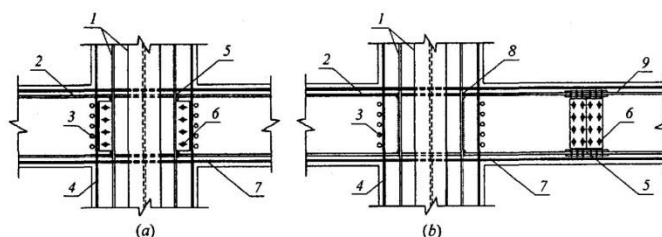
Соединения профилей колонны и балки: *a* - сварное на стройплощадке; *b* - болтовые на стройплощадке; 1 - профиль в колонне; 2 - профиль в балке; 3 - отверстия; 4 - главная арматура в колонне; 5 - сварки при монтаже; 6 -
